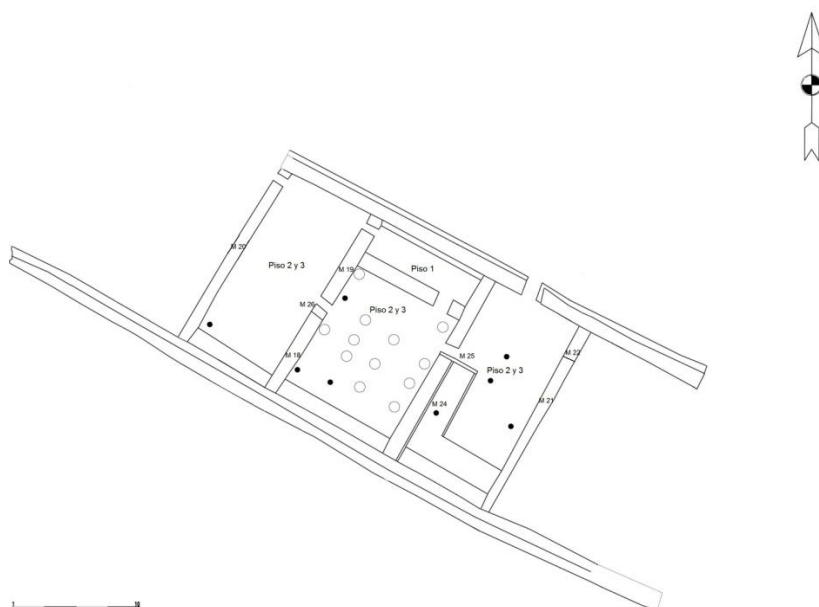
(2).- Fase constructiva 6: plano
